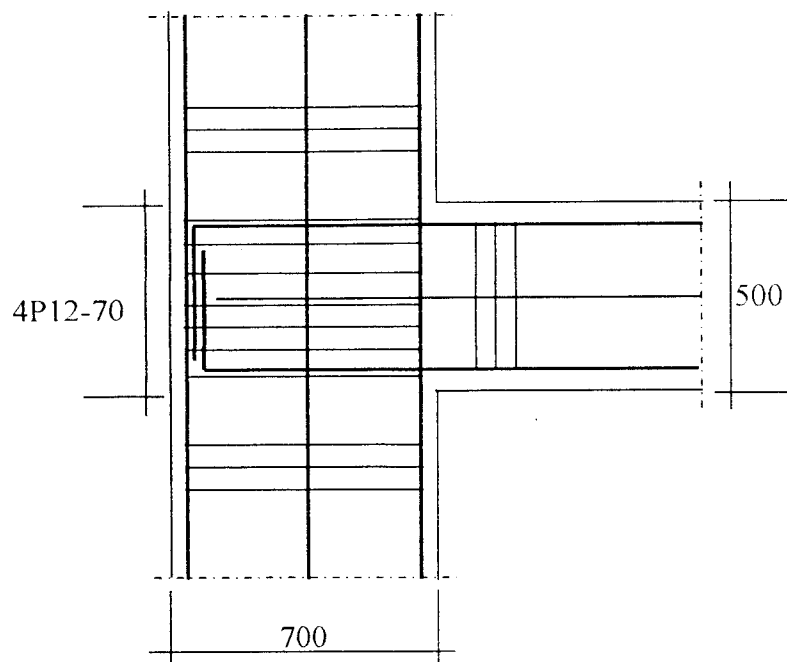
Detail Joint Balok-Kolom D Lantai 10 dan 11
